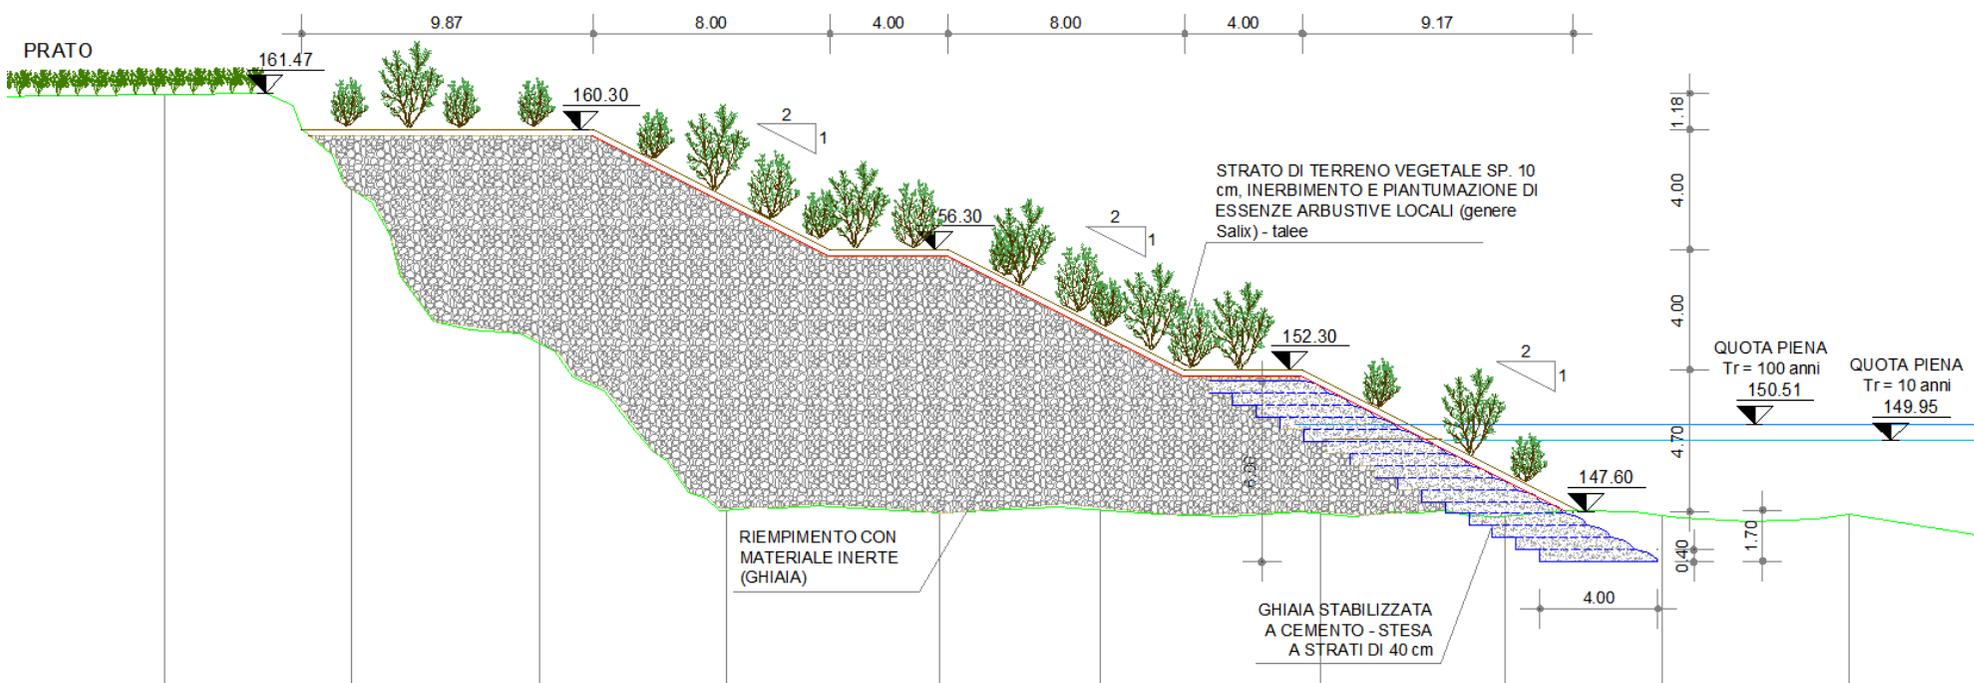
sezione tipo del ripristino spondale con ghiaia stabilizzata.
